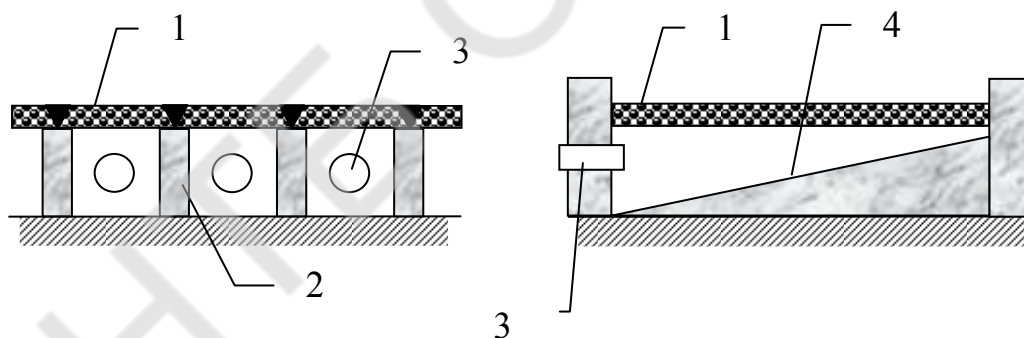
Схема нижнего полимербетонного дренажа: 1 – полимербетонная плита; 2 – опорная бетонная стенка; 3 – патрубок большого сопротивления; 4 – набетонка.
